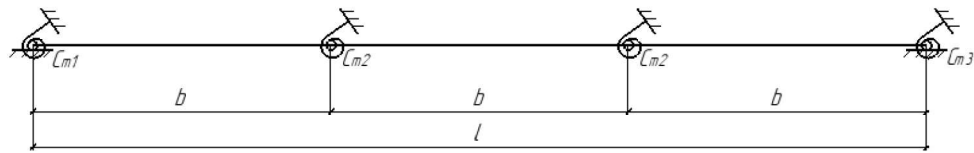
Расчетная схема нижнего пояса для расчета по методу № 2 (b — длина панели ППФ)
